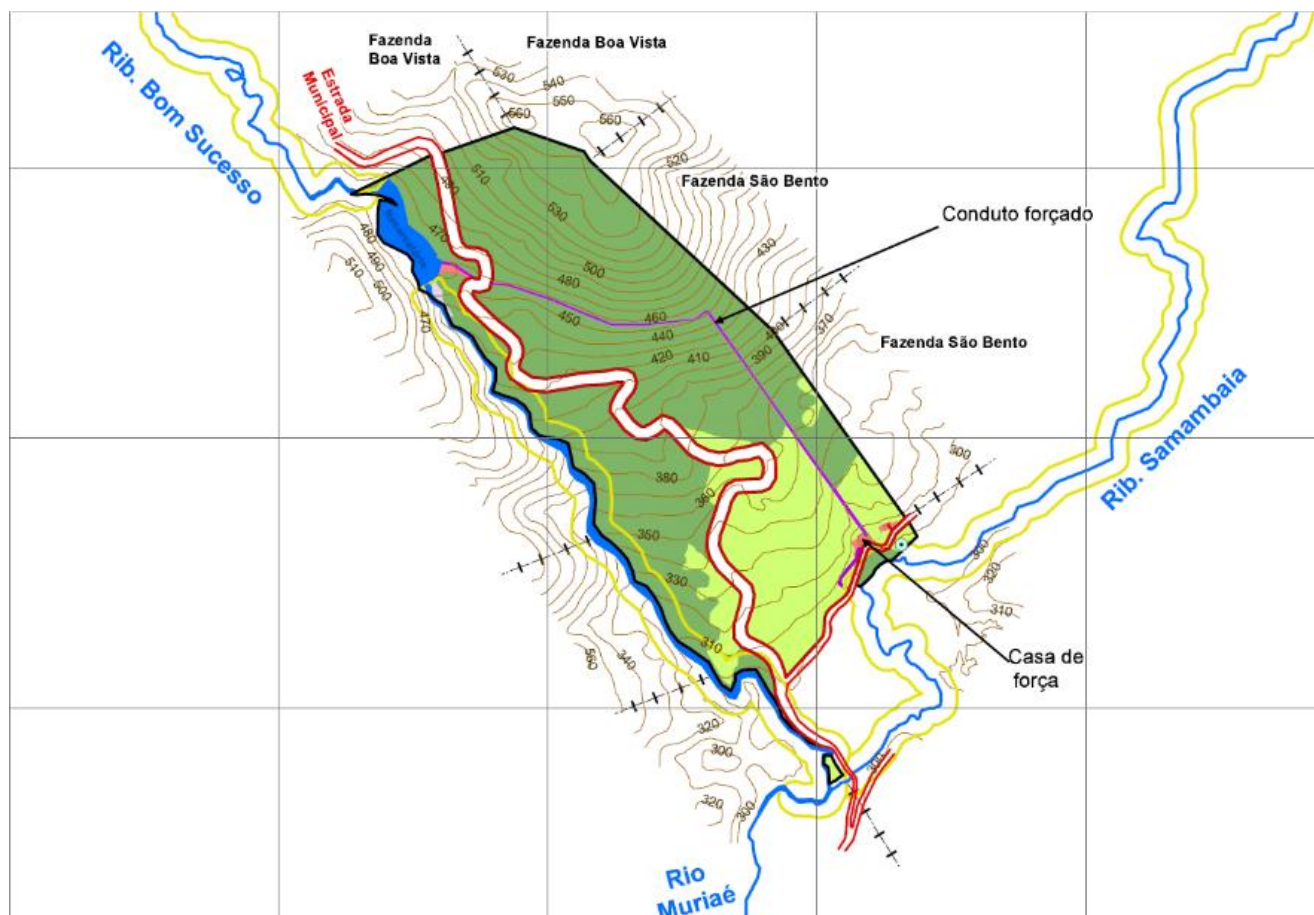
Planta Planialtimétrica da CGH Santa Cecília (recorte). Fonte: RADA.
